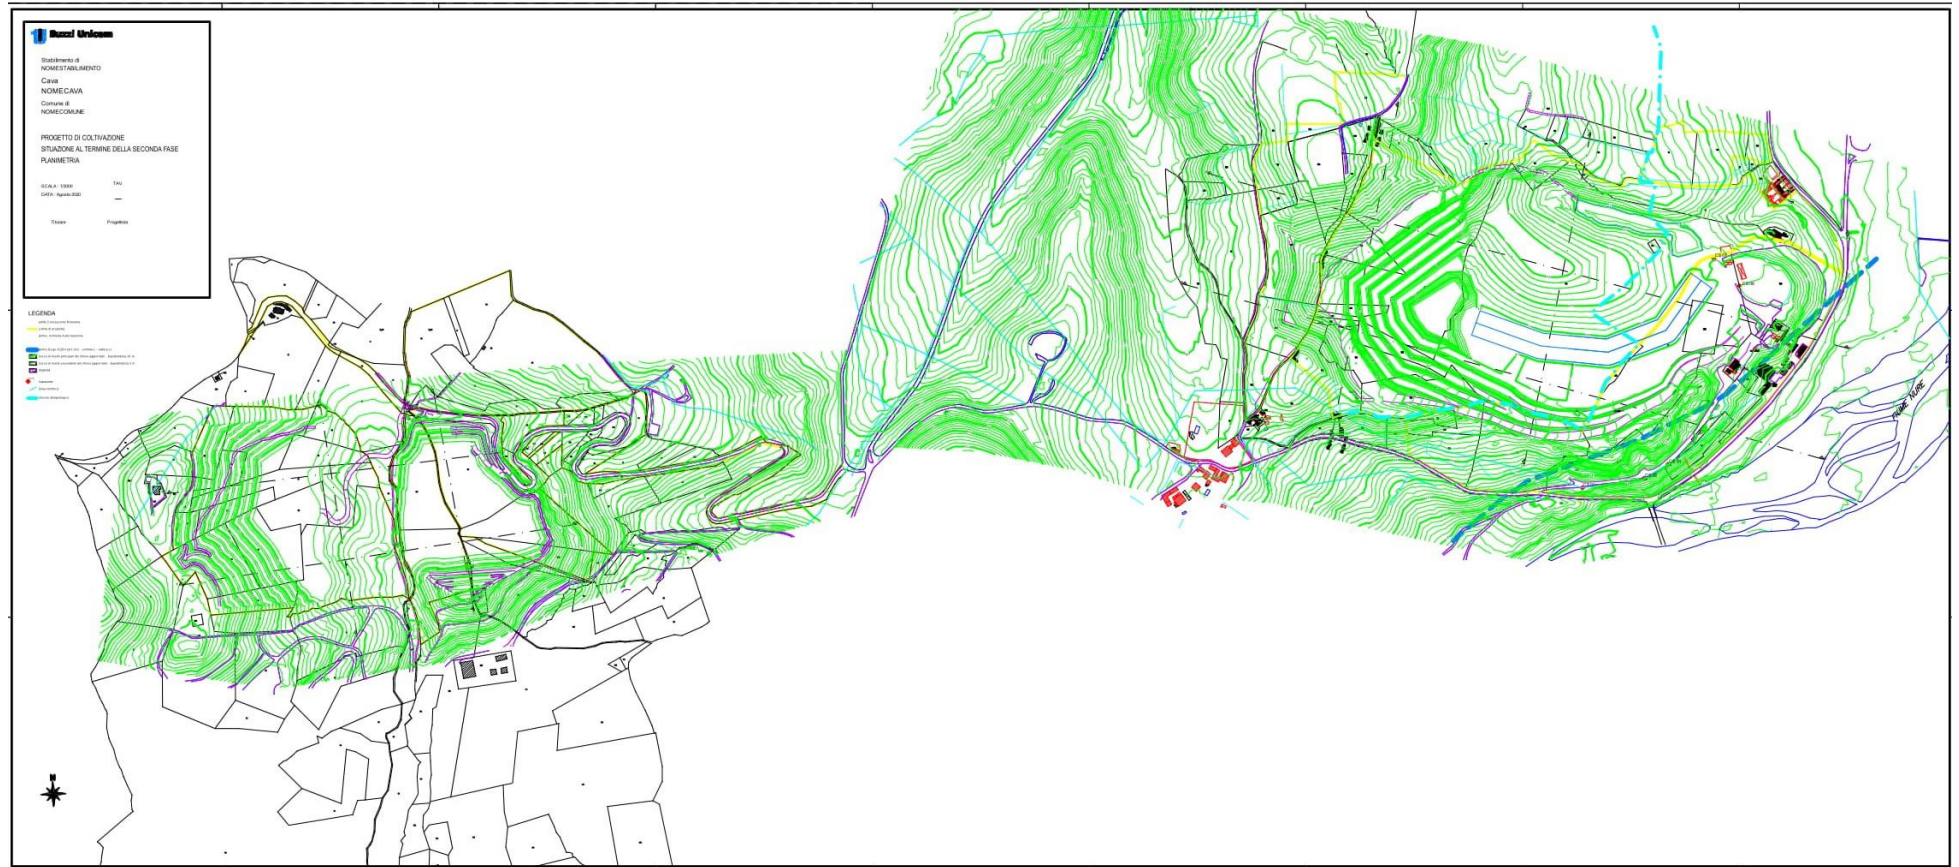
Planimetria di progetto - Fase 3 (15 anni)
